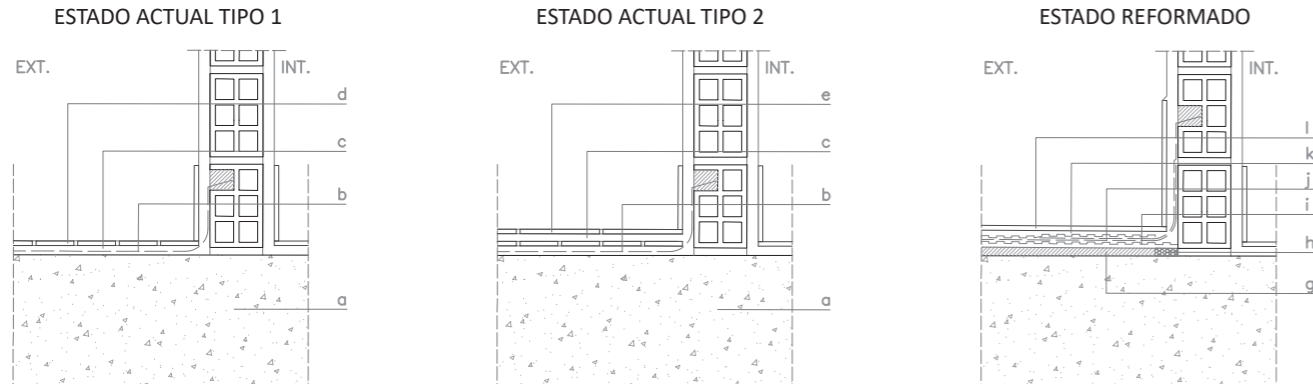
Detalle constructivo. Impermeabilización patios interiores. [Tabla 2]
